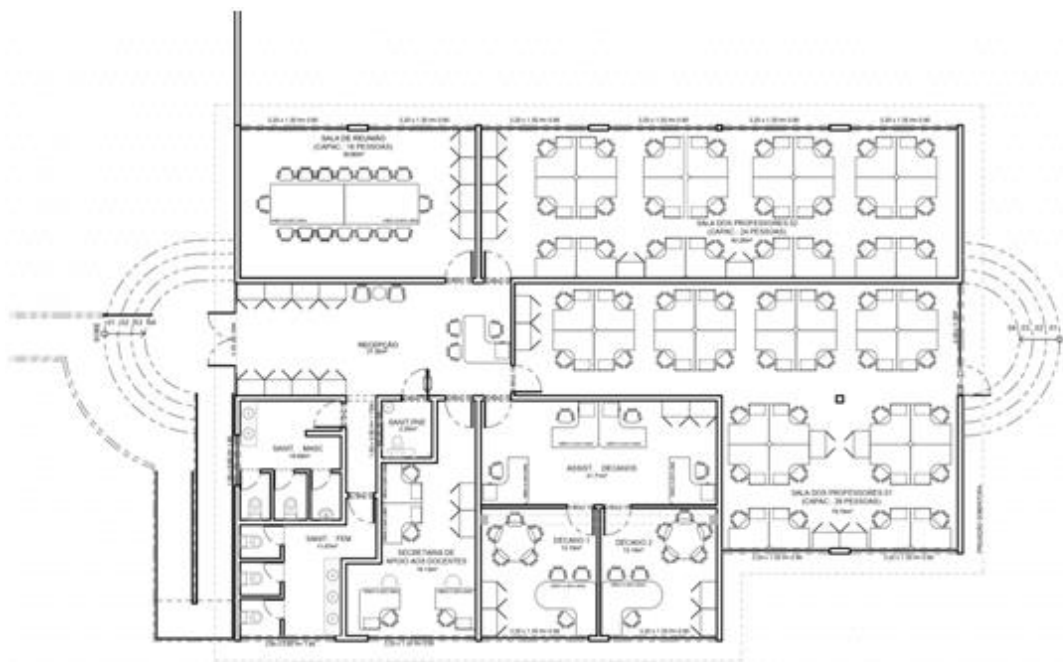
Layout das instalações físicas do Pavilhão de Aulas do Complexo I
